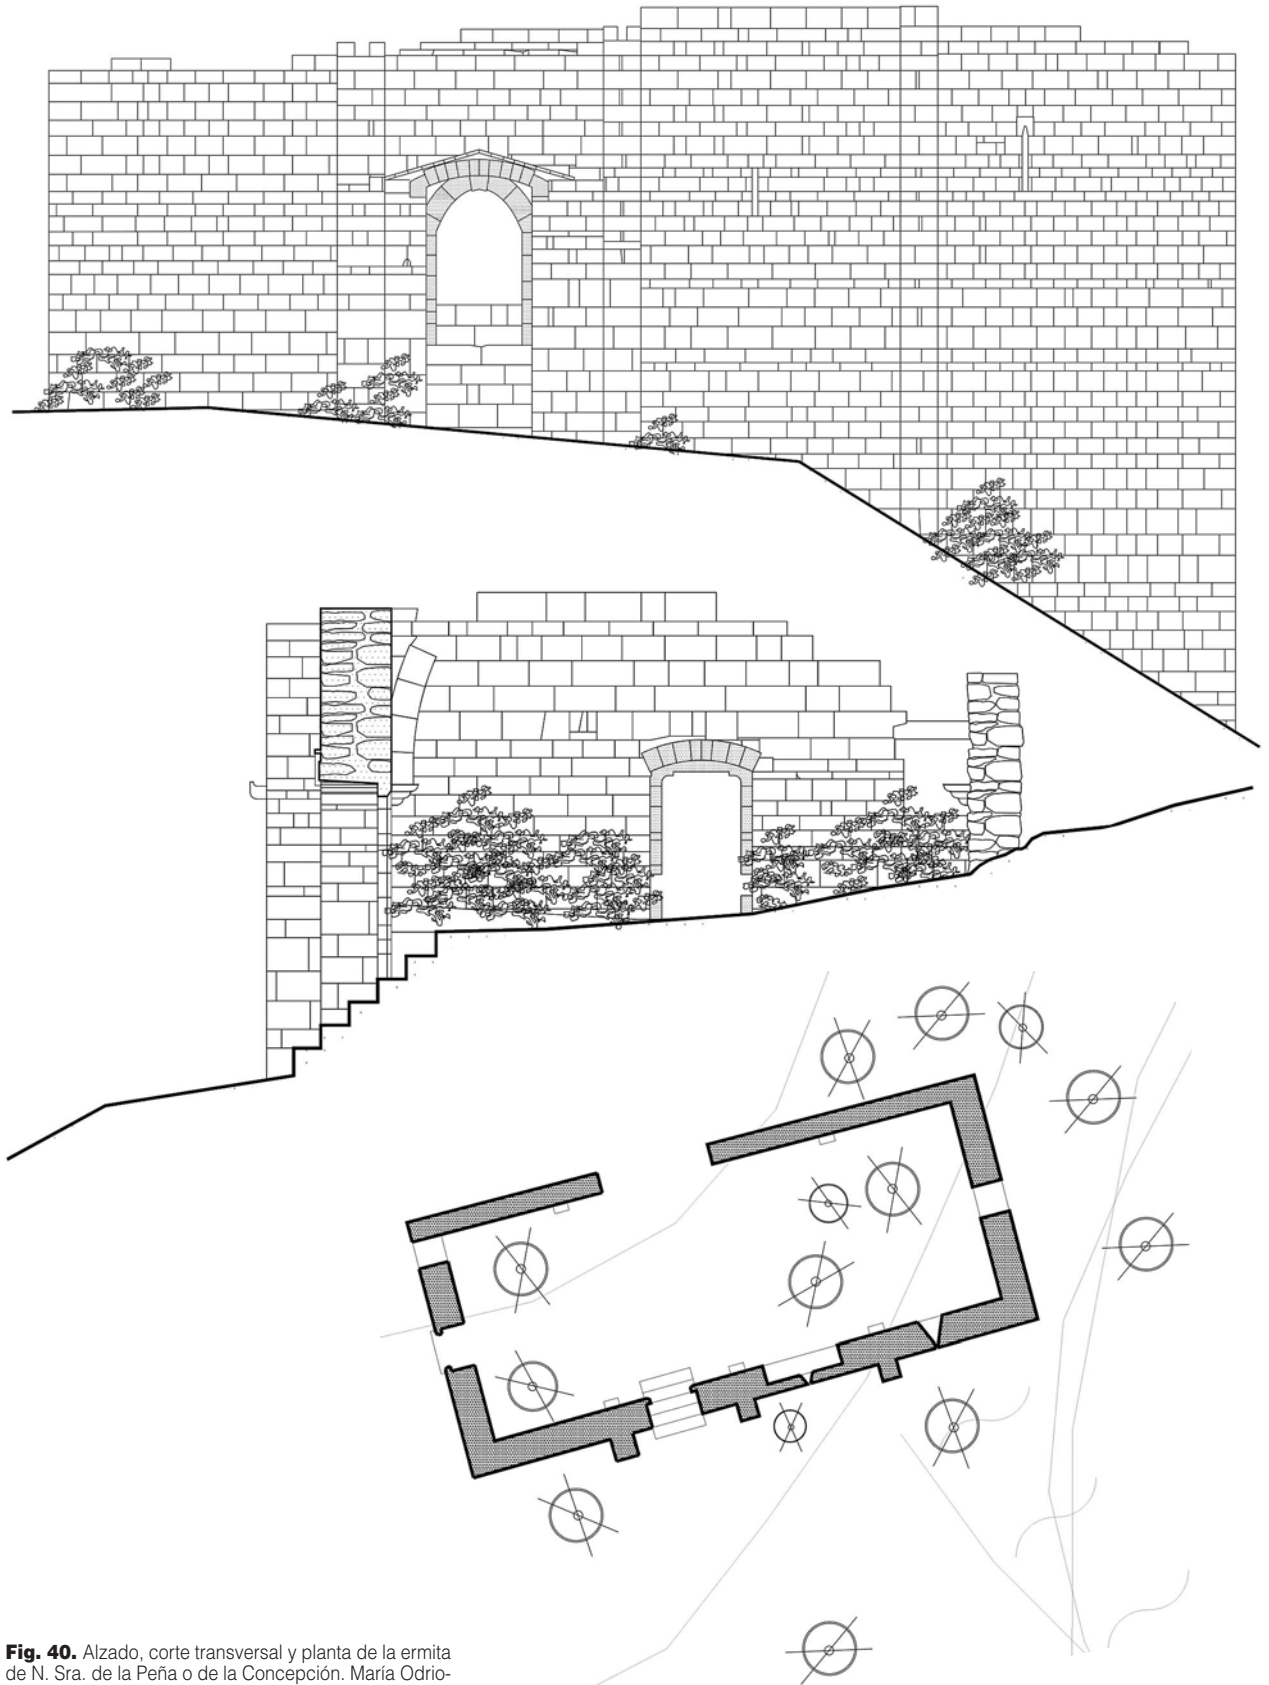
Alzado, corte transversal y planta de la ermita de N. Sra. de la Peña o de la Concepción. María Odriozola Soraluze. Alumna de arquitectura. UPV-EHU.
